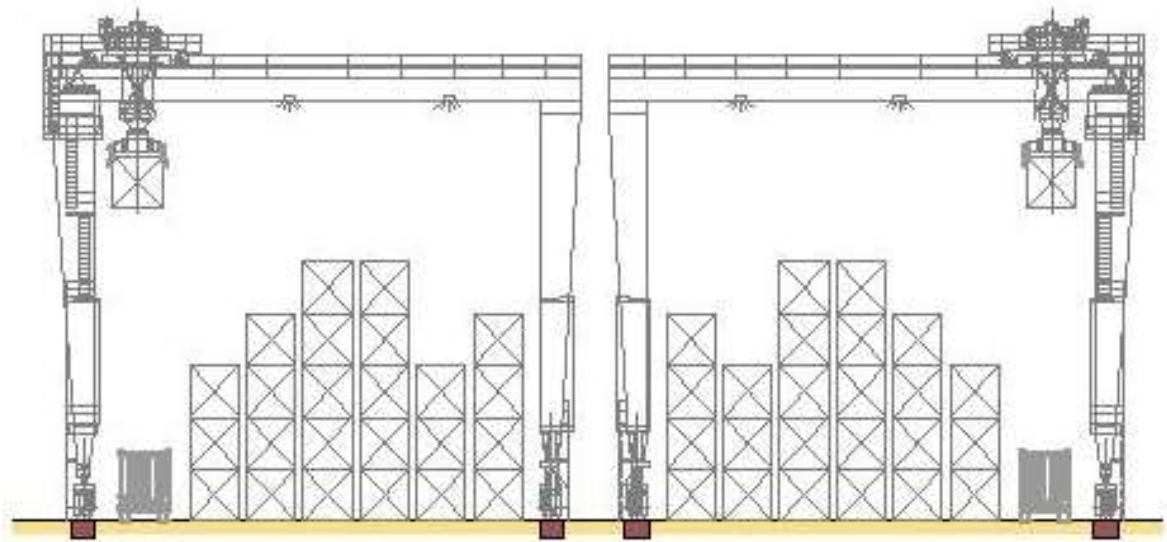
Voie de roulement pour grues RTG – Coupe transversale
